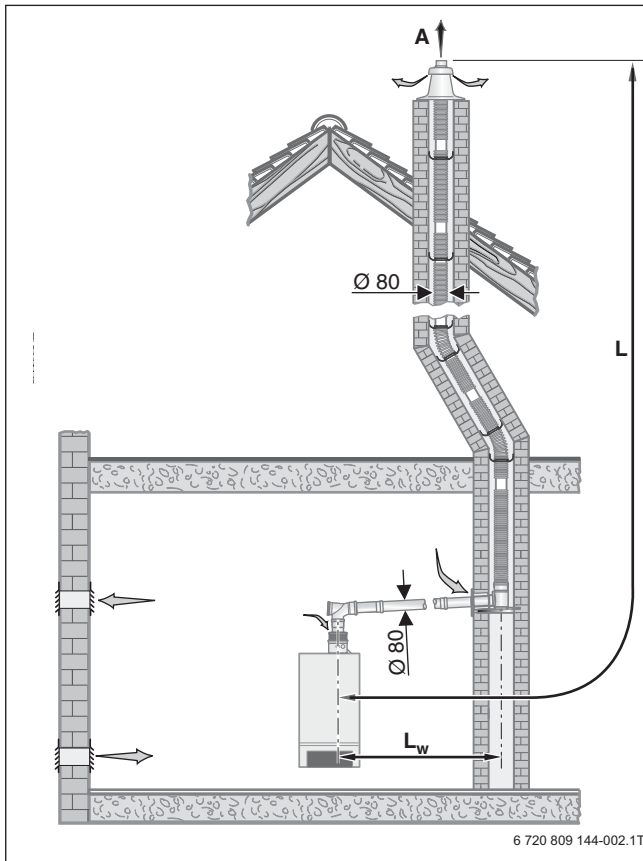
Montagevariante mit dem Bausatz GA + UB-Flex
